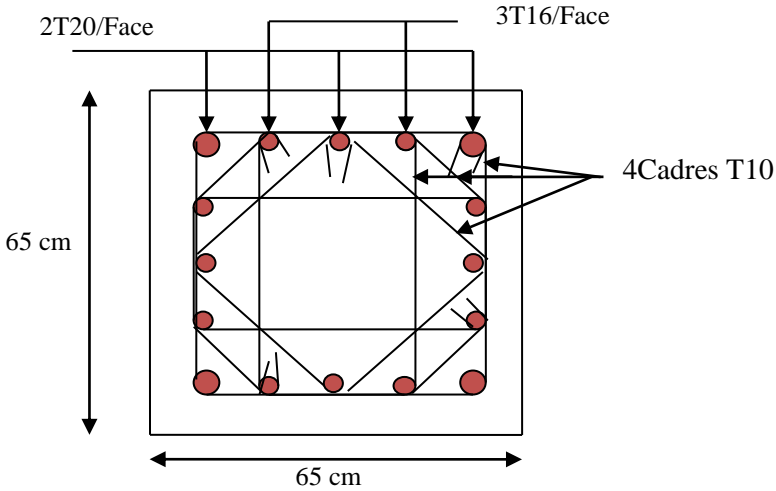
Schéma de ferrailage des poteaux de RDC.
